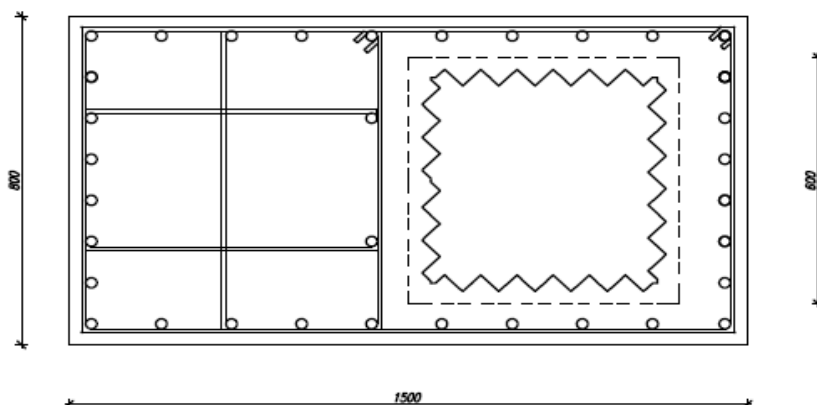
Secção transversal de um pilar dos grupos 2 e 3
